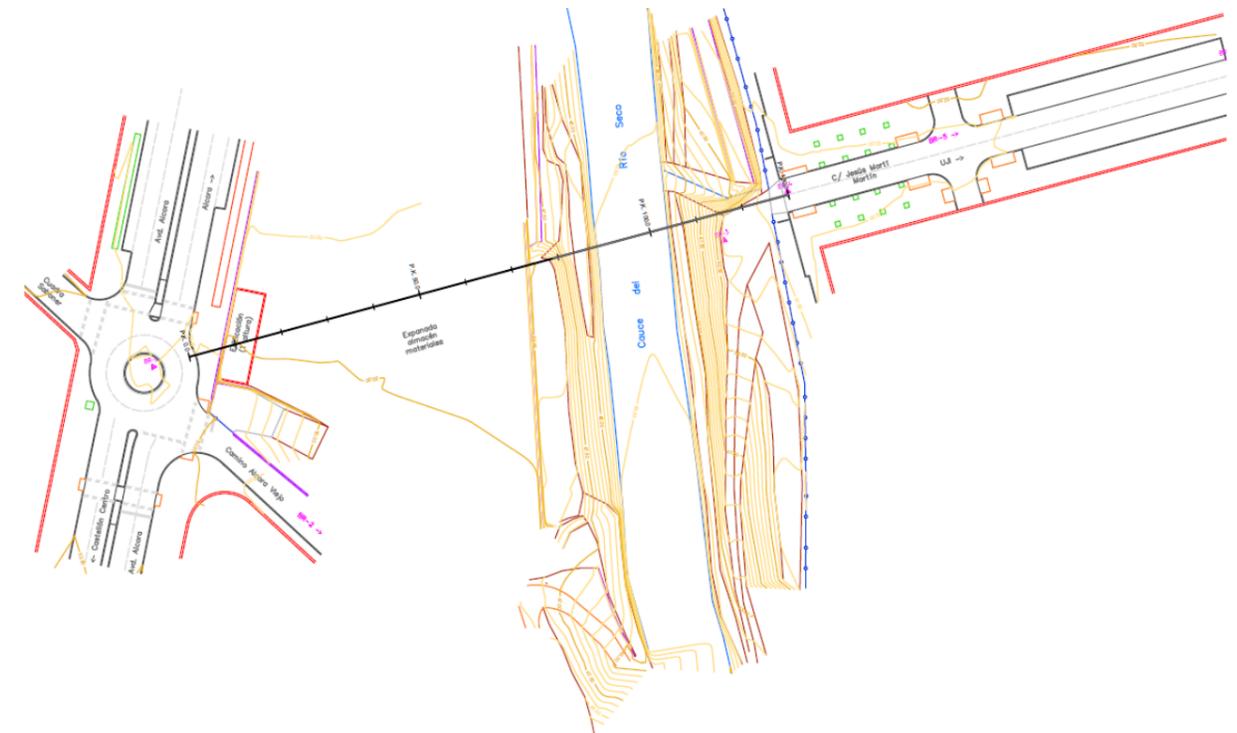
Trazado en planta del tramo de calle a ejecutar (figura extraída del Plano nº3: Planta general de actuaciones).
